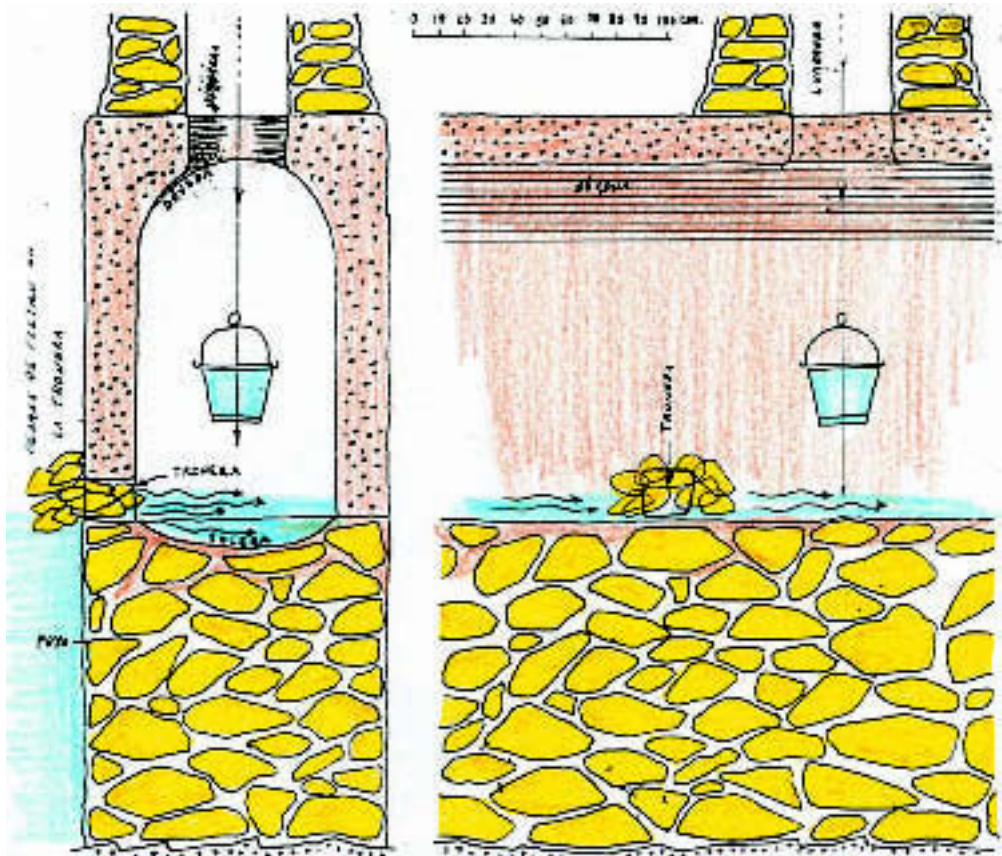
Sección transversal y longitudinal del Contracaño. El agua accede al interior de la galería por troneras con filtro de piedra en seco.
